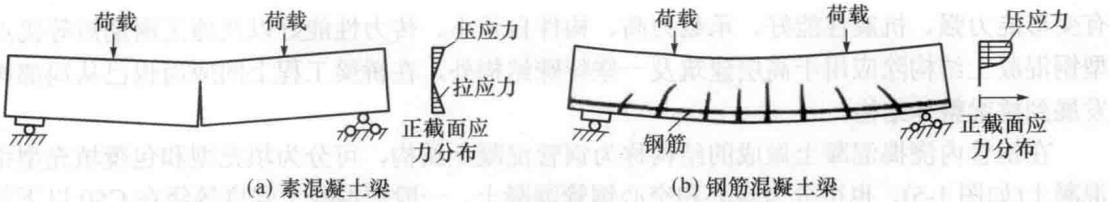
钢筋混凝土梁与素混凝土梁的比较
